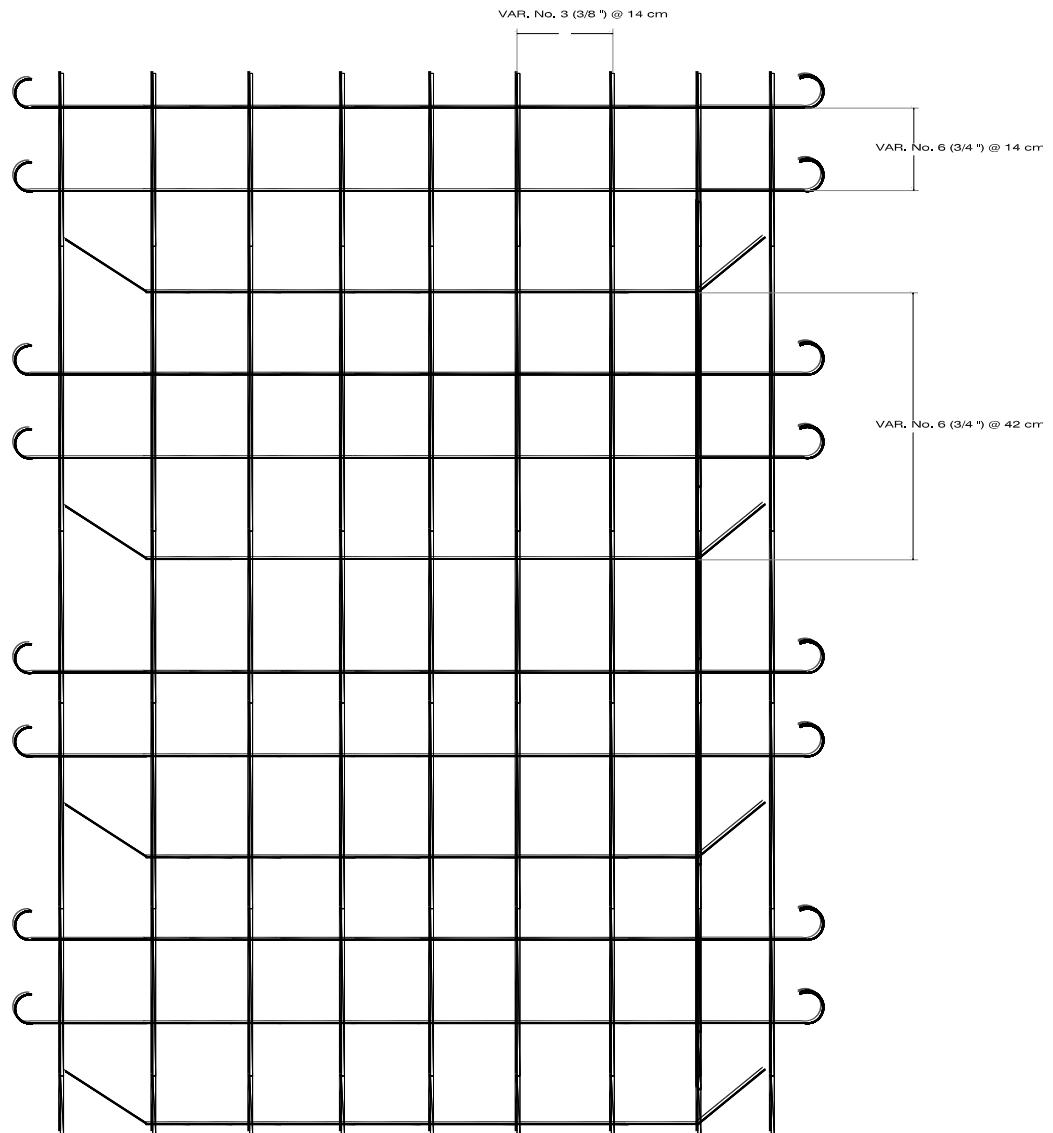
Armado de losa y separación de las barras (en planta) para alcantarilla 1.
